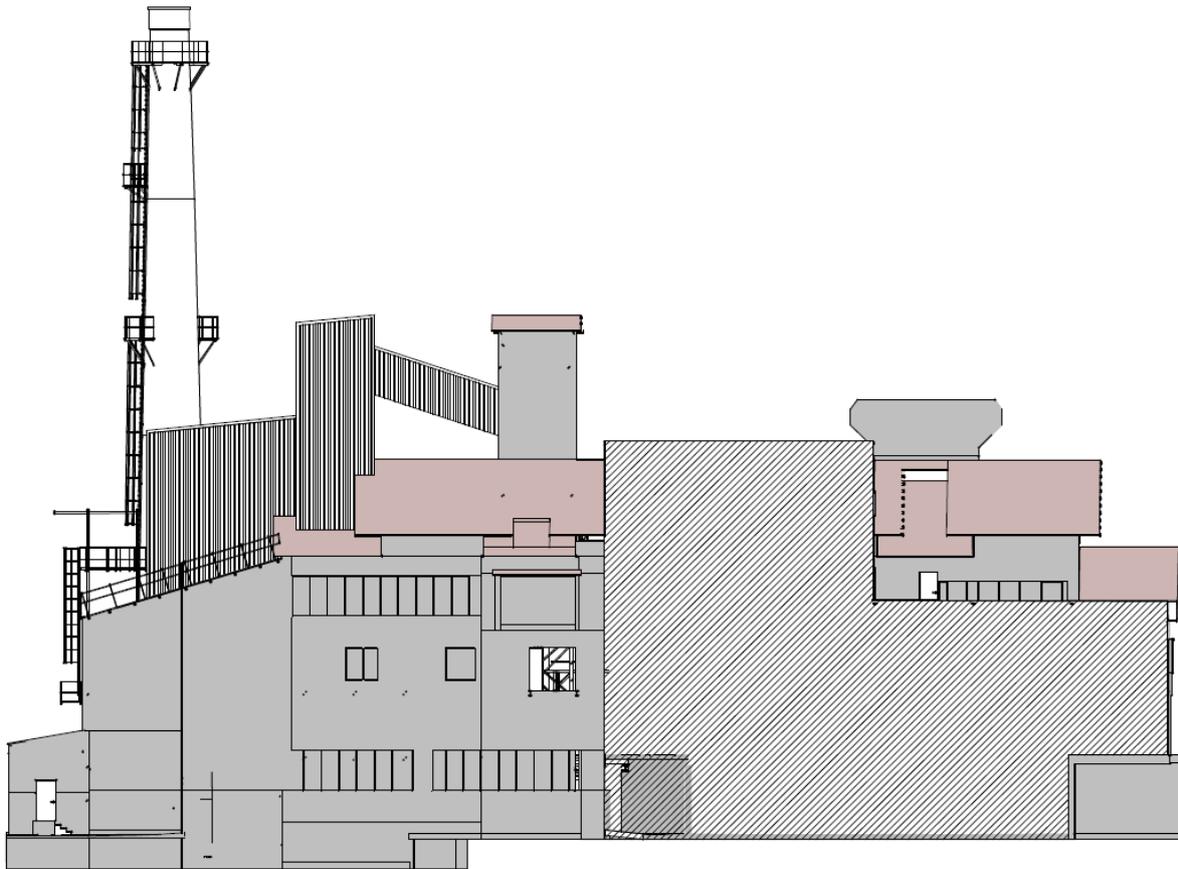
Plan projeté du bâtiment accueillant le four 4 avec réhausse de toiture - Façade Est
